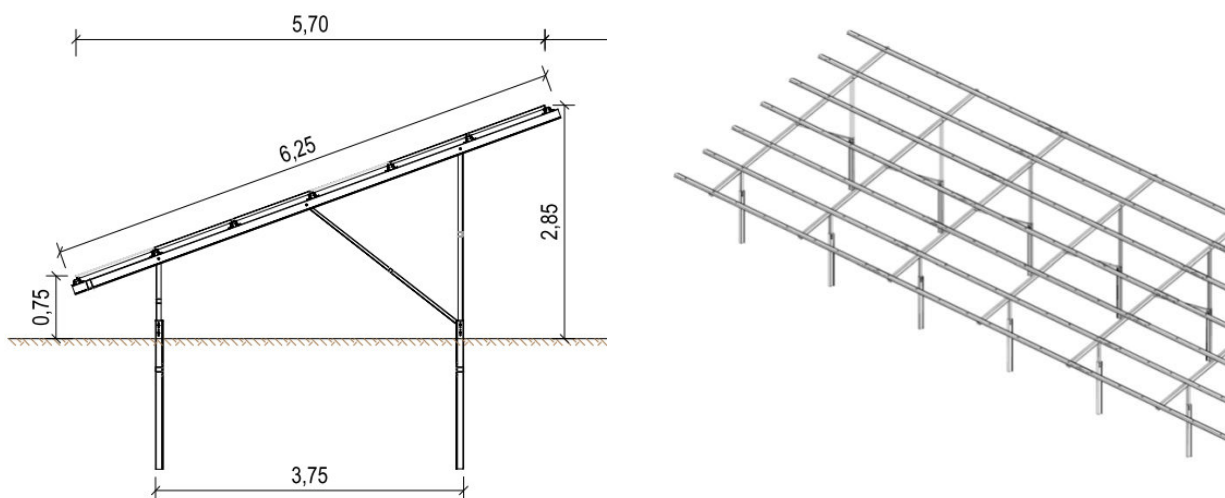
Skizze der Modulkonstruktion (Quelle: Planungsunterlagen)
